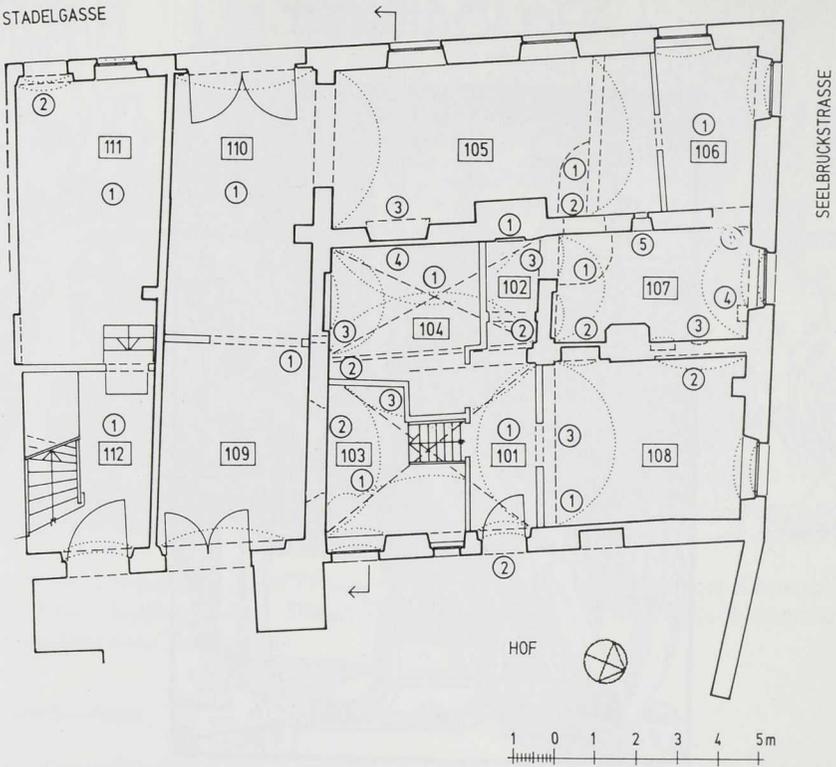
Ravensburg, Stadelgasse 1, Grundriß Erdgeschoss
